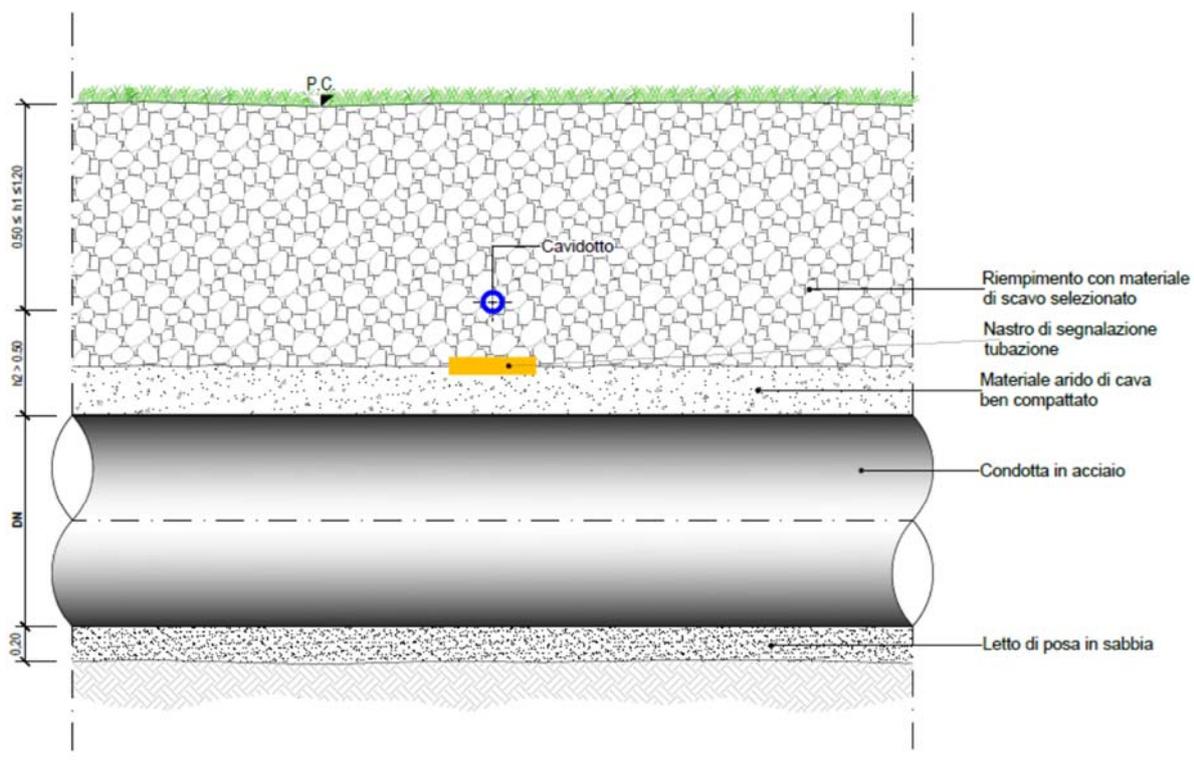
Sezione tipologica di attraversamento cavidotti interrati.
